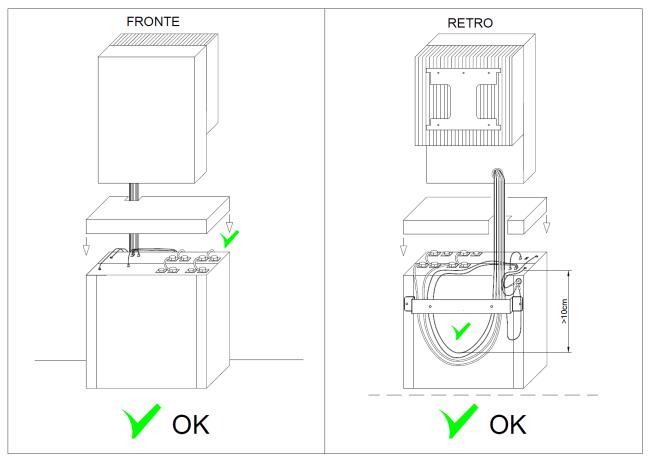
Disposizione cavi CORRETTA con evidenza di ansa sul retrp tra wall-box e batterie.
